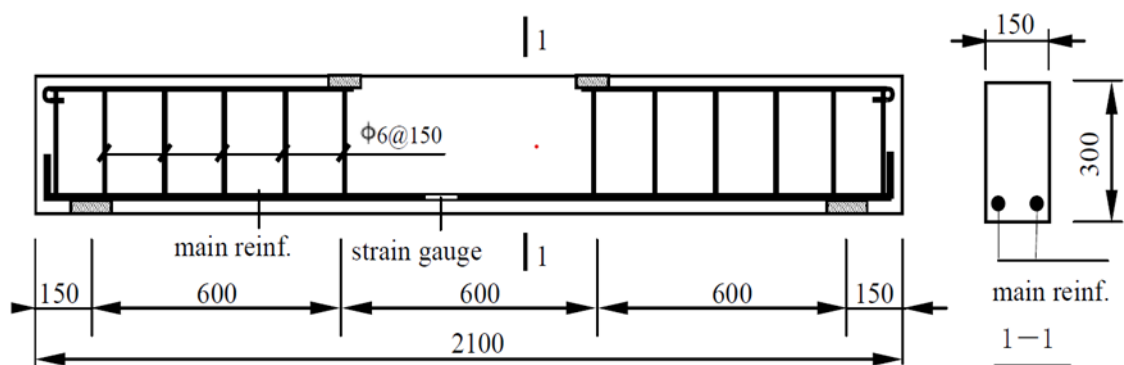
Essai de flexion 4 points et plan de ferrailage [49].
